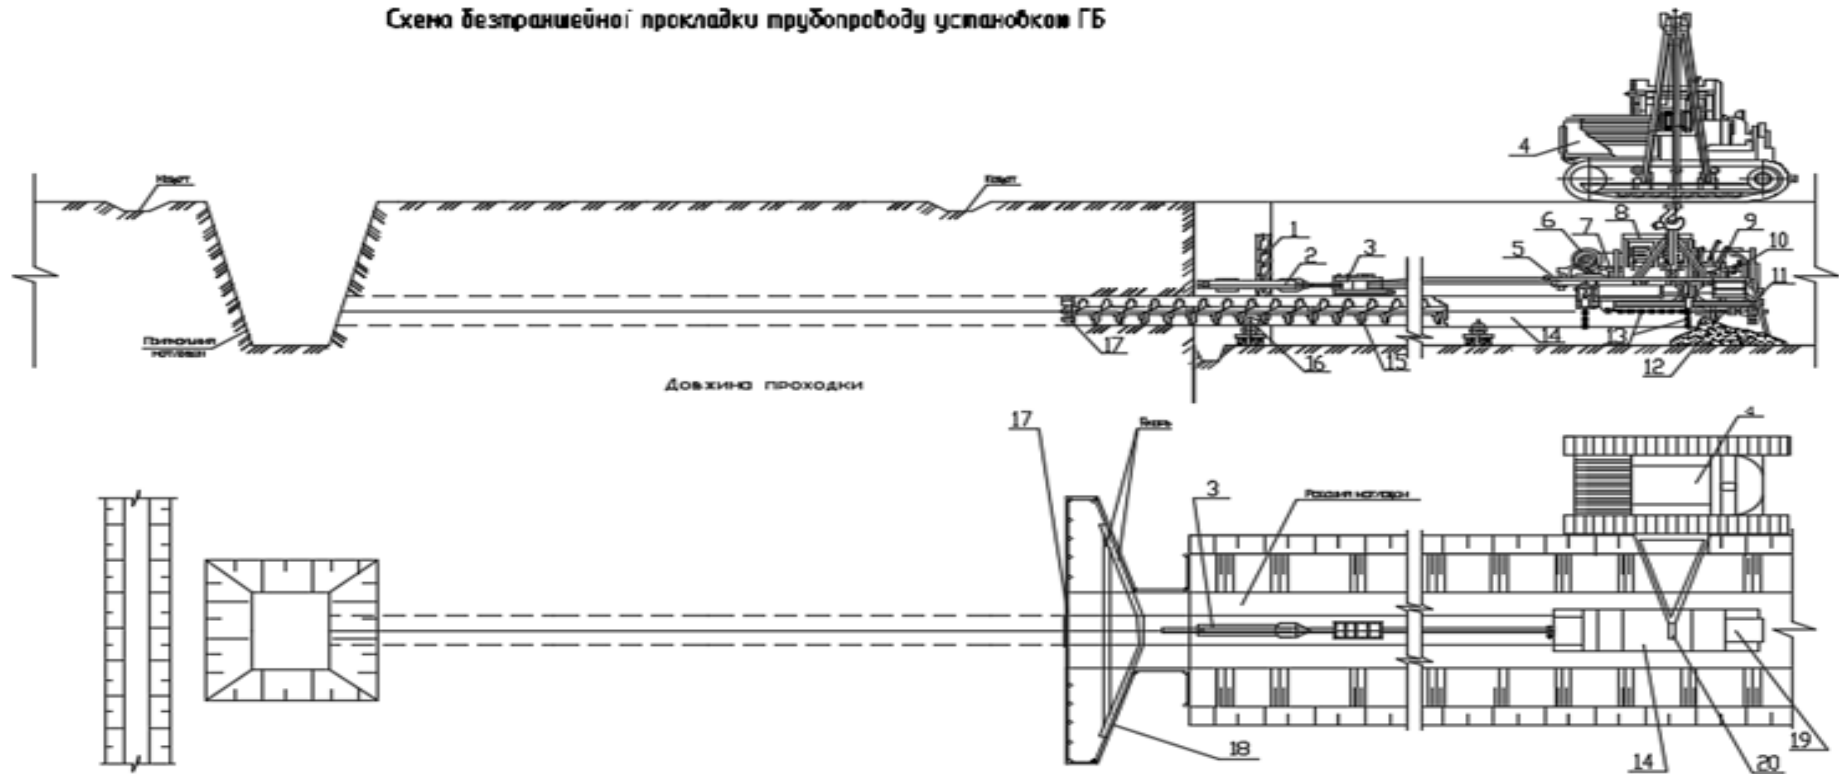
Схема безтраншейної прокладки труби:
